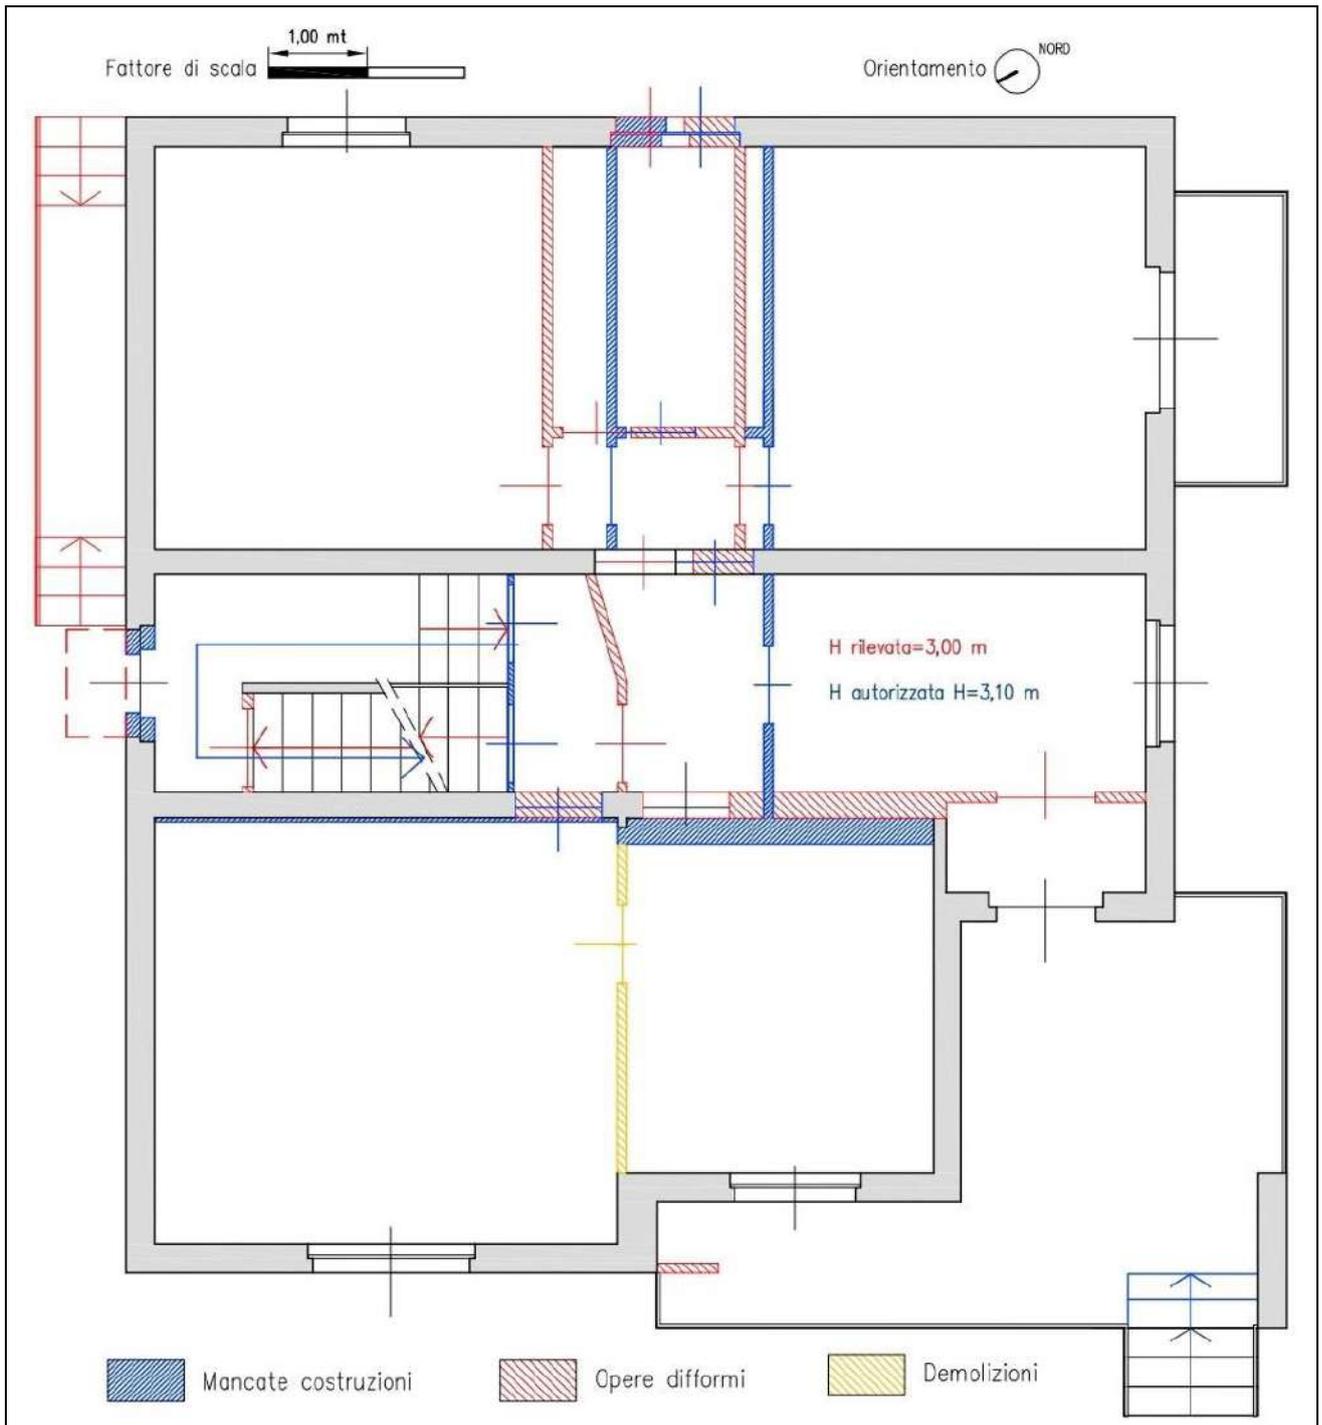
Pianta piano rialzato - confronto con Licenza di Costruzione n. 1289 del 04.03.1968
